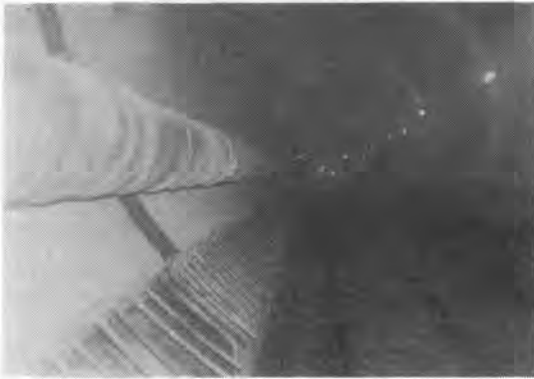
風管用つる巻きパイプ (φ400) 敷設状況
